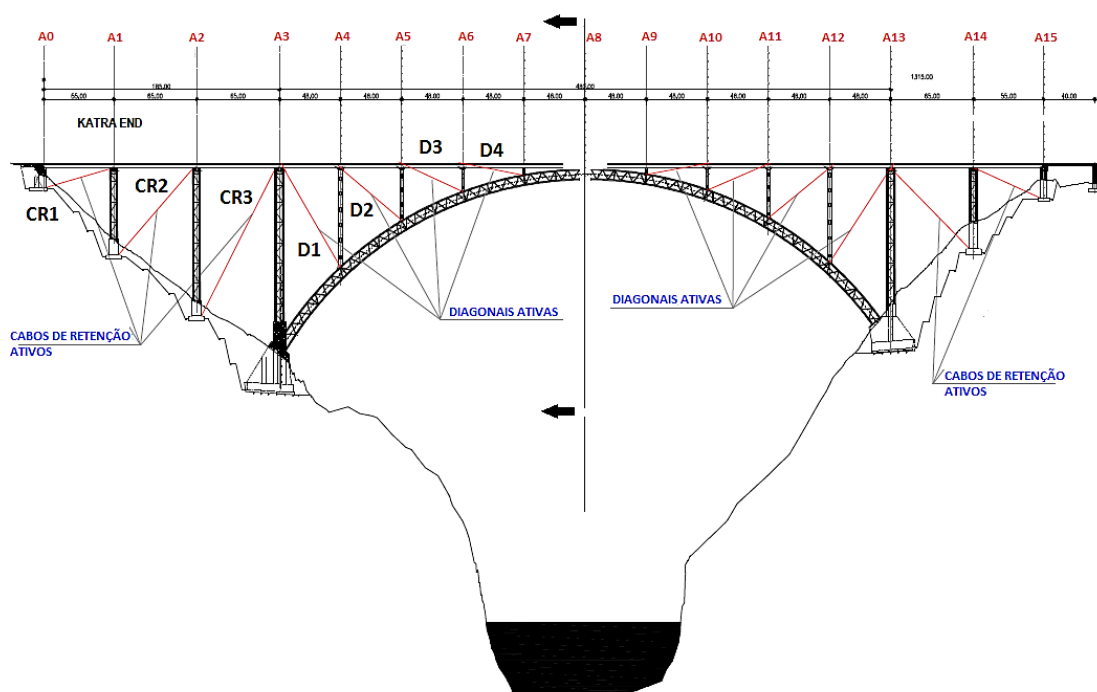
Disposição esquemática do sistema de atirantamento ativo proposto (fase final).
